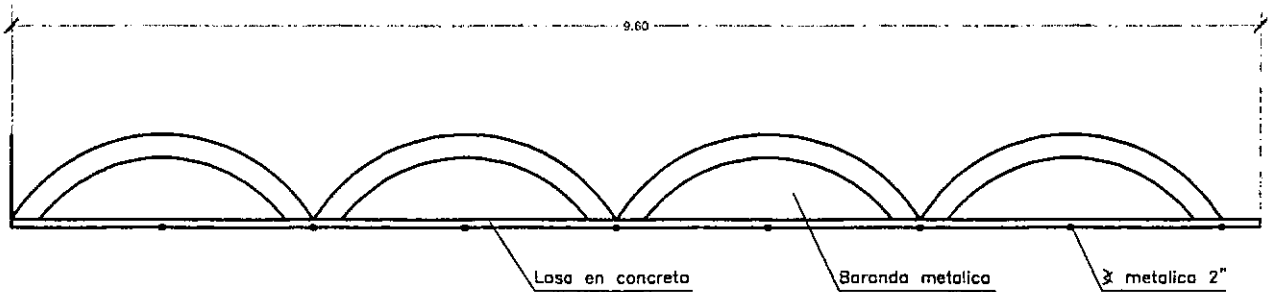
INS P - F10 VISTA LATERAL PUENTE PEATONAL COLEGIO SCOUT
